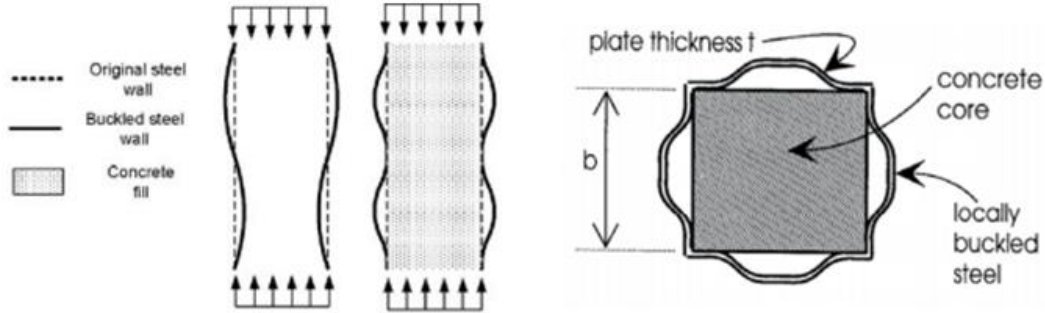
Pandeo local en pilares vacíos y rellenos de hormigón
